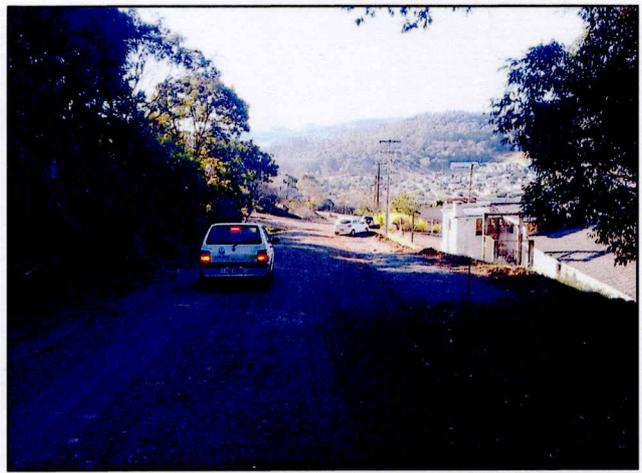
Foto 10 – vista norte do leito da Rua existente a ser regularizada, conforme ponto 01 do projeto;
